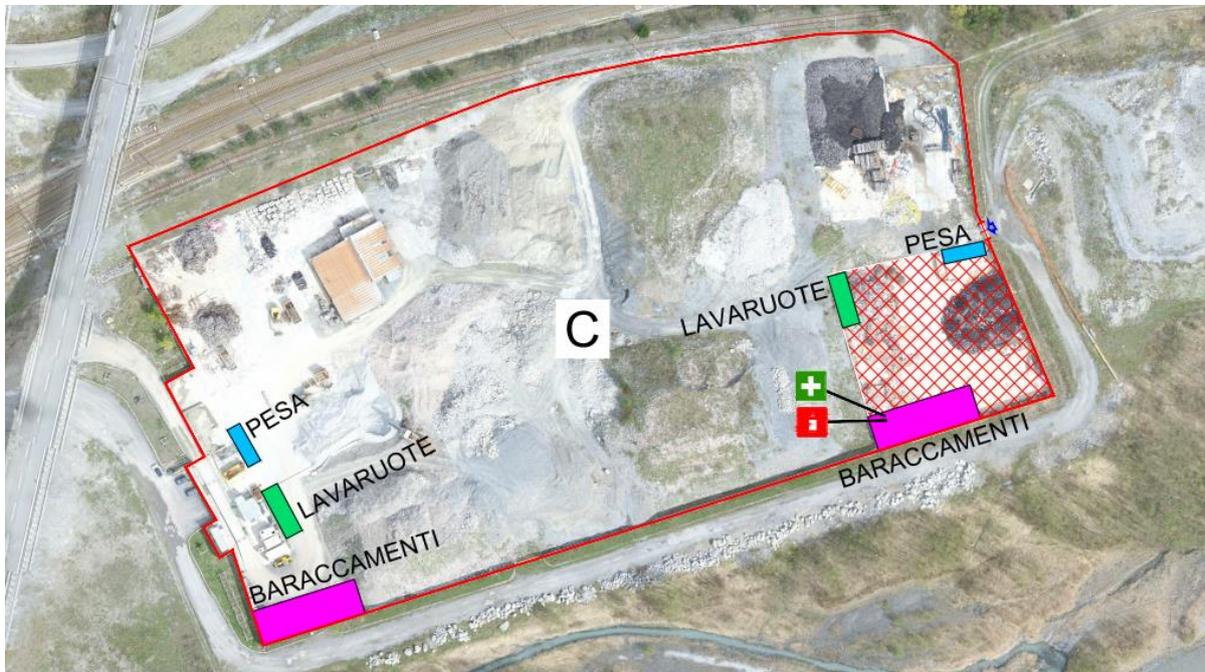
Area di cantiere C e apprestamenti di cantiere
